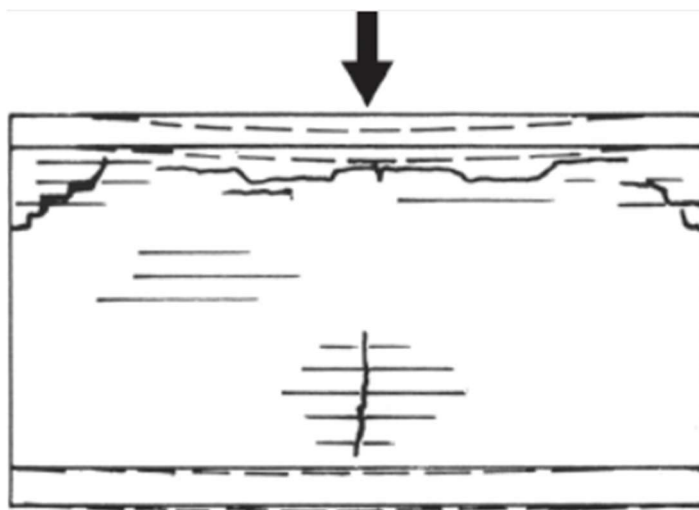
Fissura desenvolvida pela deformação dos elementos estruturais, com a maior deformação do elemento inferior.
